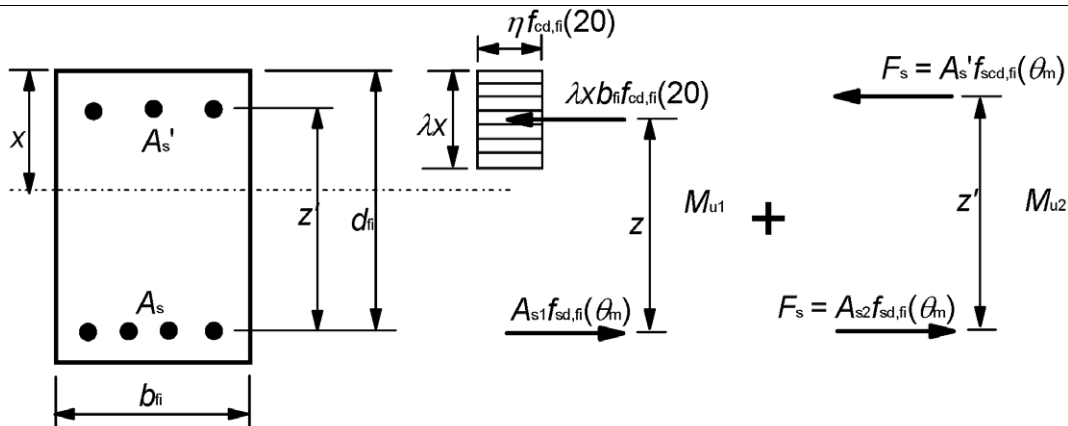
B.1 Sección transversal reducida de una viga y pilar de hormigón armado
